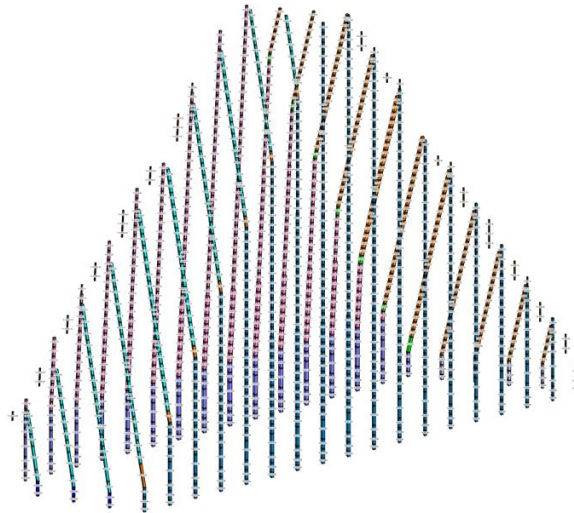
Repérage des poteaux de façade de la Tour Triangle © Herzog & De Meuron
